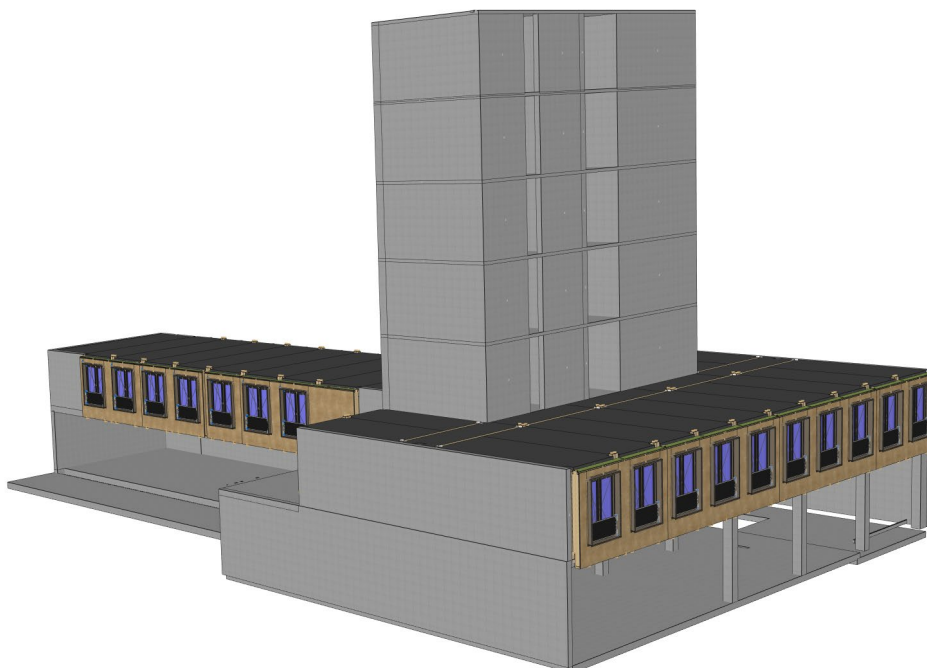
Planung Montage nicht tragender Außenwandelemente (Sieveke)
